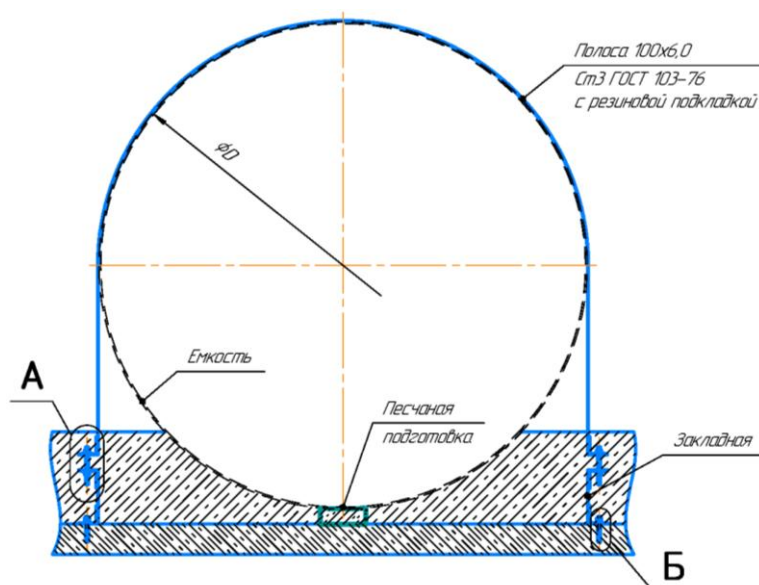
монтаж горизонтального корпуса на фундаментную плиту
